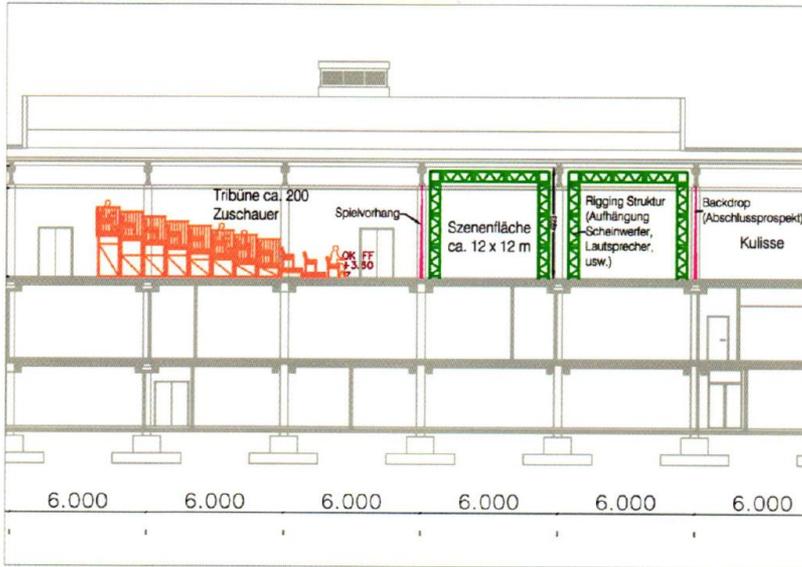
Mensa am Wall - Schnitt mit Spielstätte im großen Speisesaal
